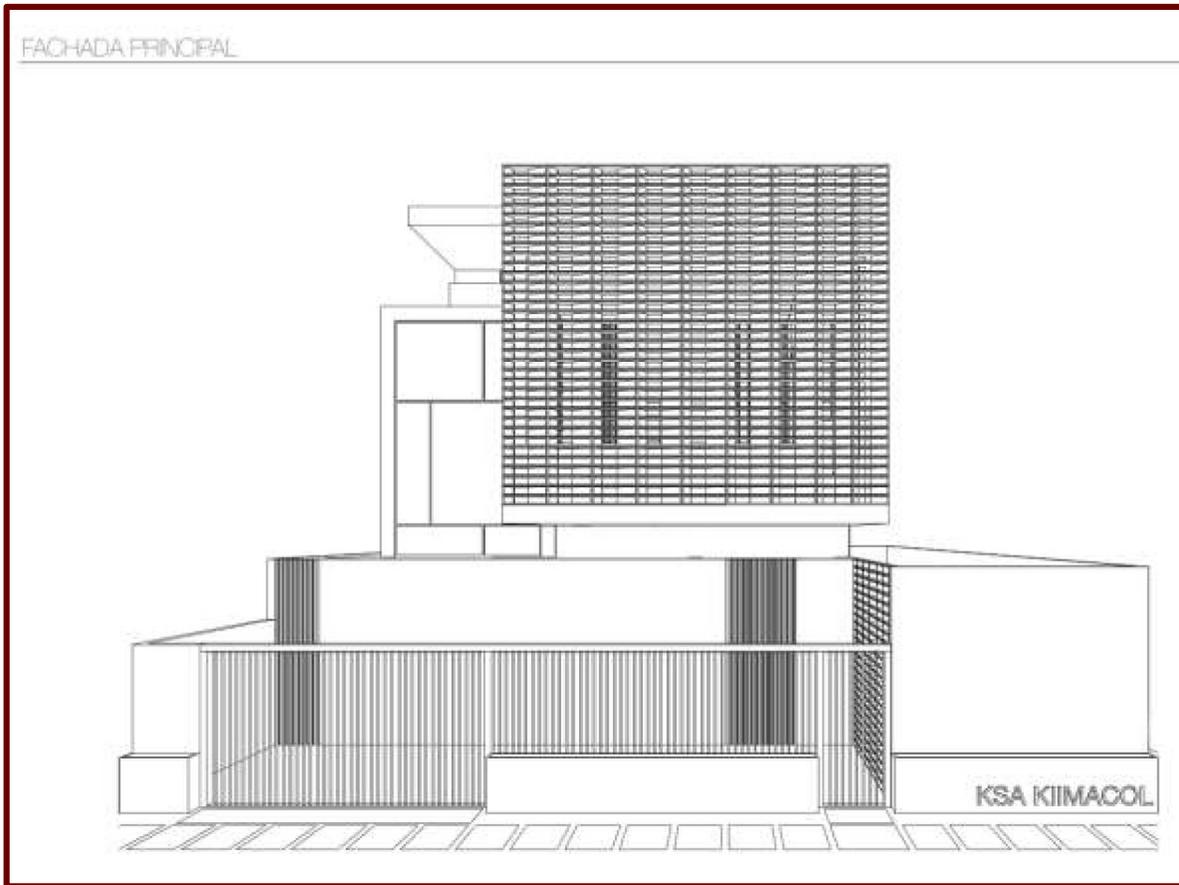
Esquema del proyecto en los niveles con la fachada correspondiente.
